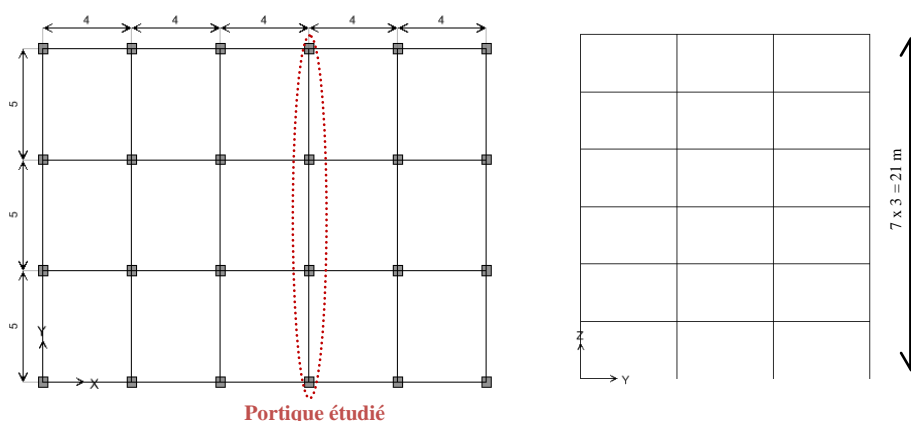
Vue en plan et en élévation de la structure étudiée.
